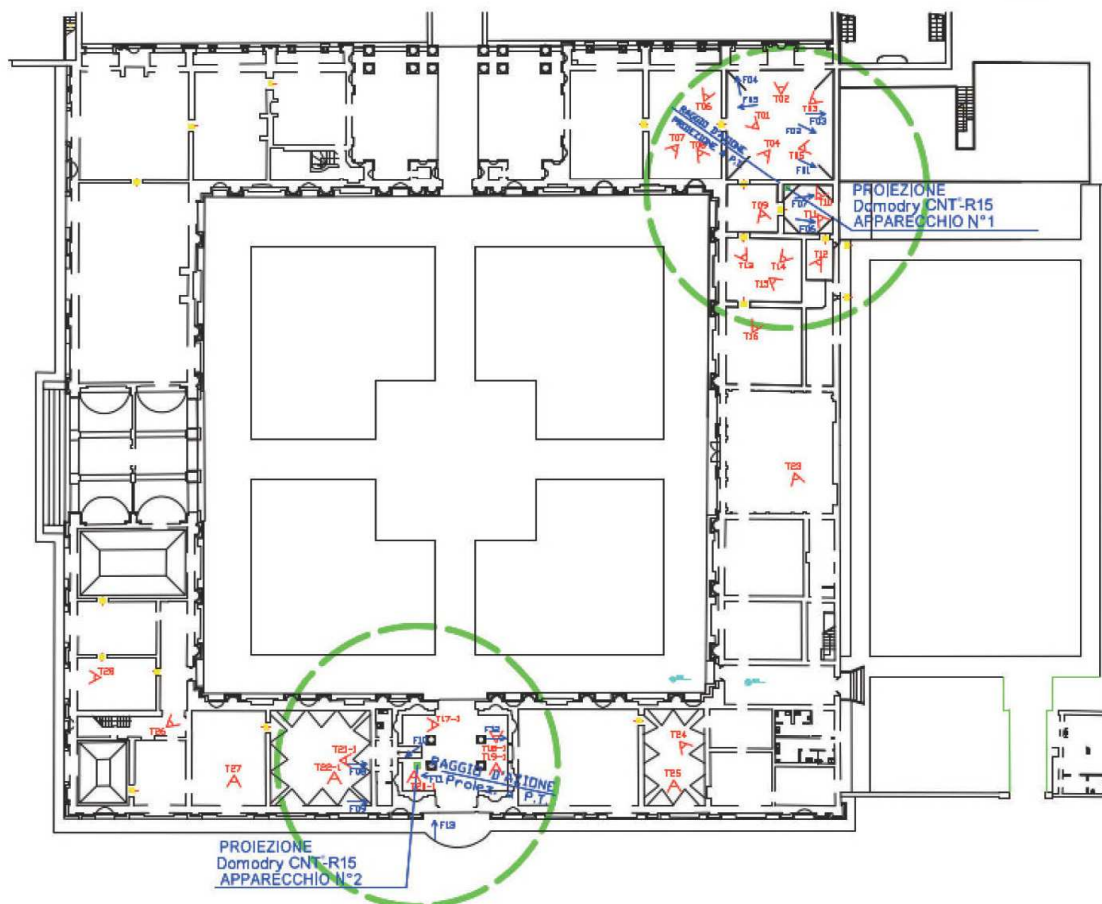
Palazzo Te: schema planimetrico dei dispositivi CNT installati
